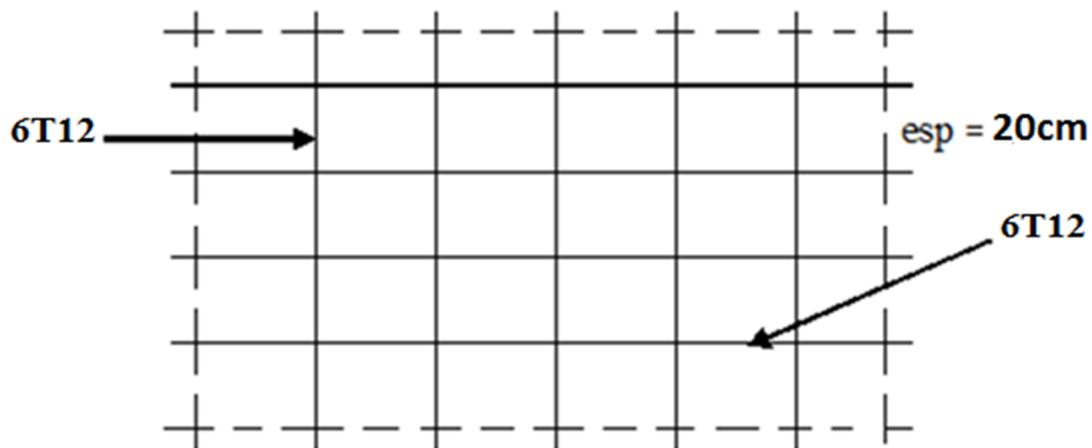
La disposition du ferrailage du voile 20cm.
